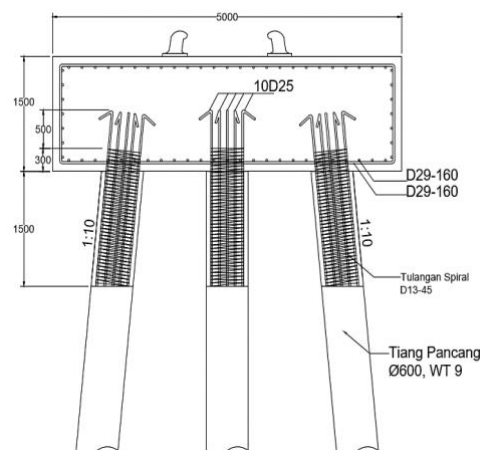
Detail penulangan *pile cap breasting dolphin* tampak samping
